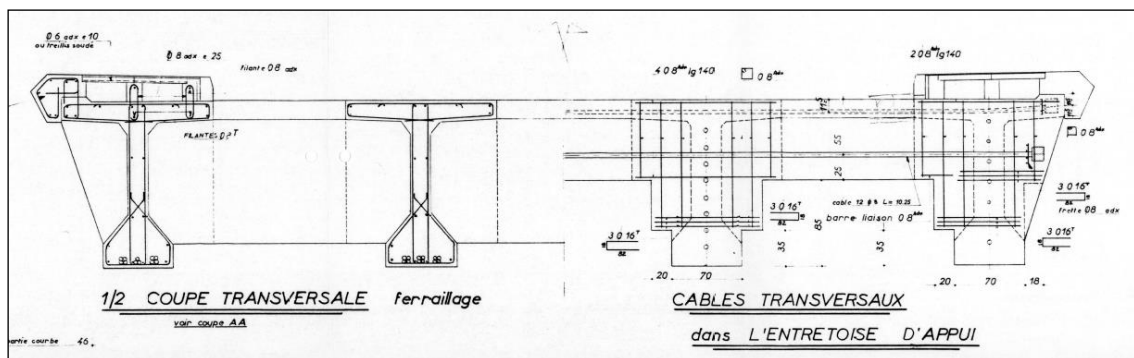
Coupe transversale d'un hourdis de VIPP avec section non ferrillée
